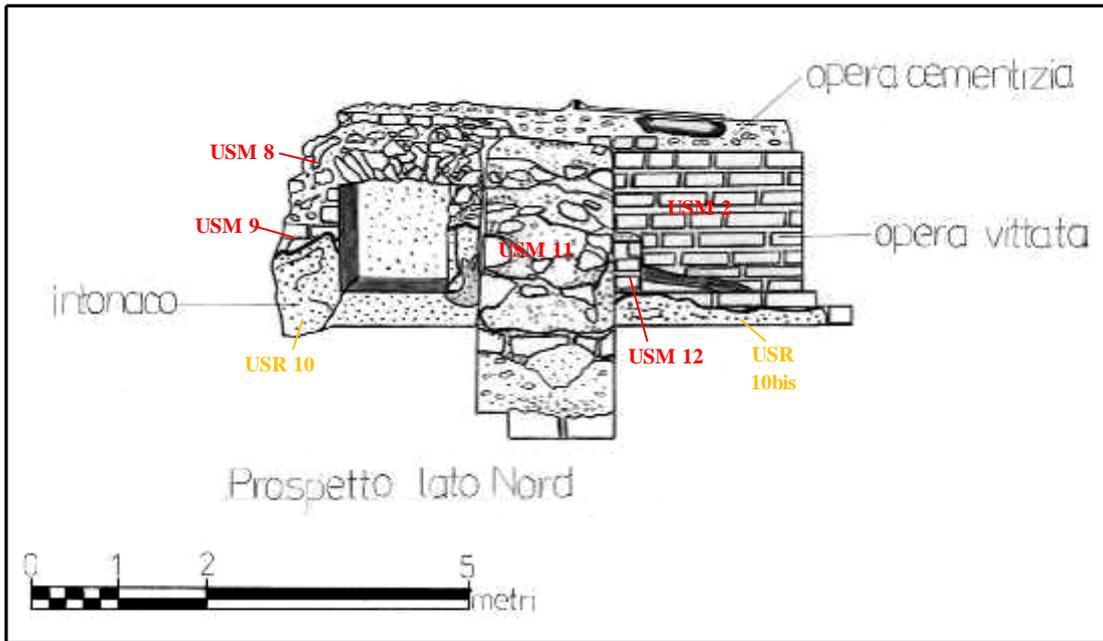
Prospetto della parete nord del mausoleo "A" (rilievo di Vincenza Iannelli).
